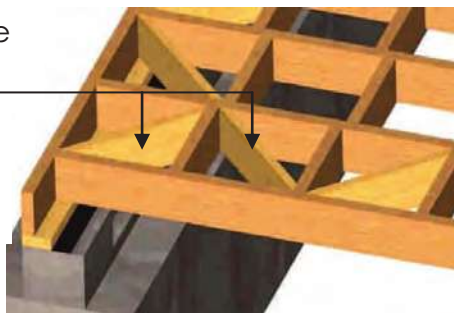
, Refuerzos de Madera en Vigas Secundarias en piso, Fuente “La Construcción de Viviendas en Madera”, p. 182
